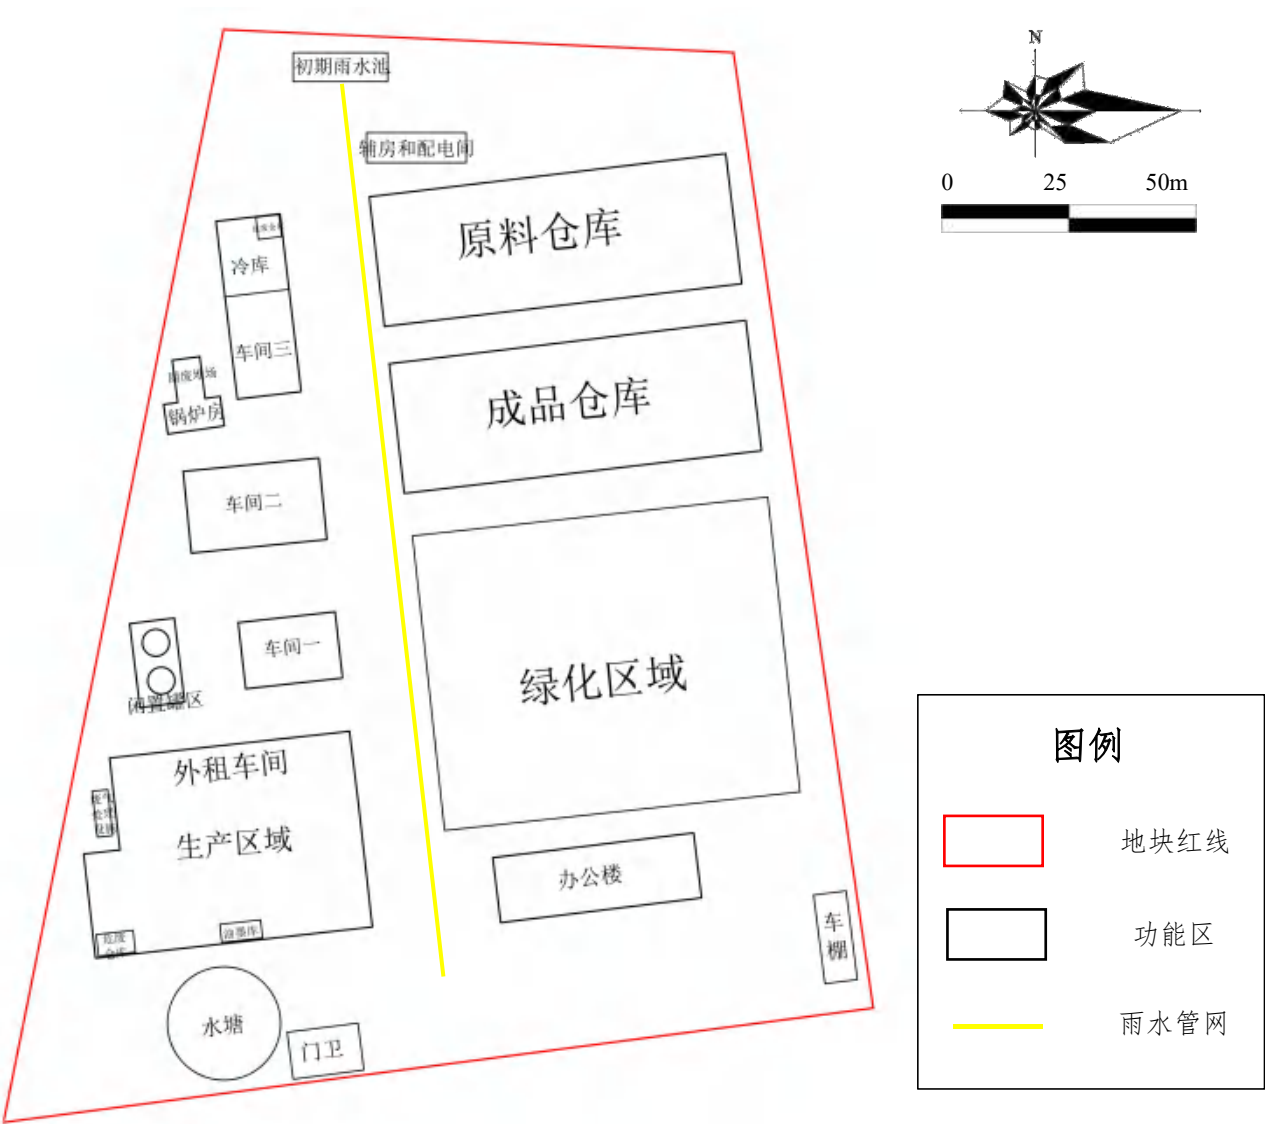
江苏万润化学有限公司厂区平面布置图
